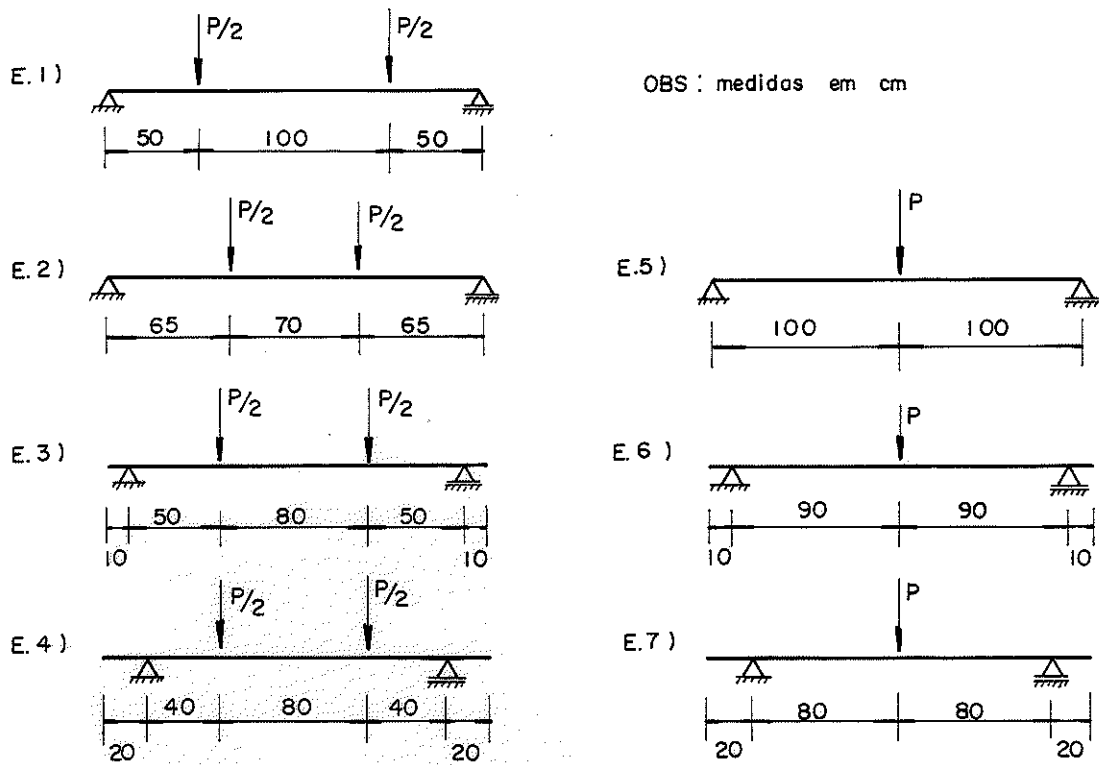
Carregamentos e vão das vigas com emendas cavilhadas
